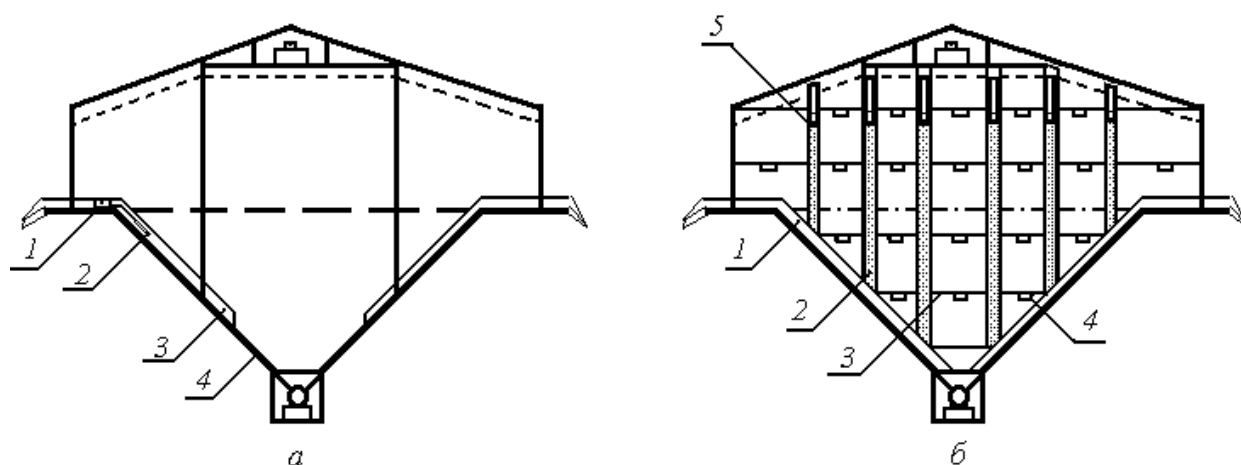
Схема стационарных установок для вентилирования зерна в складах с наклонными полами:
